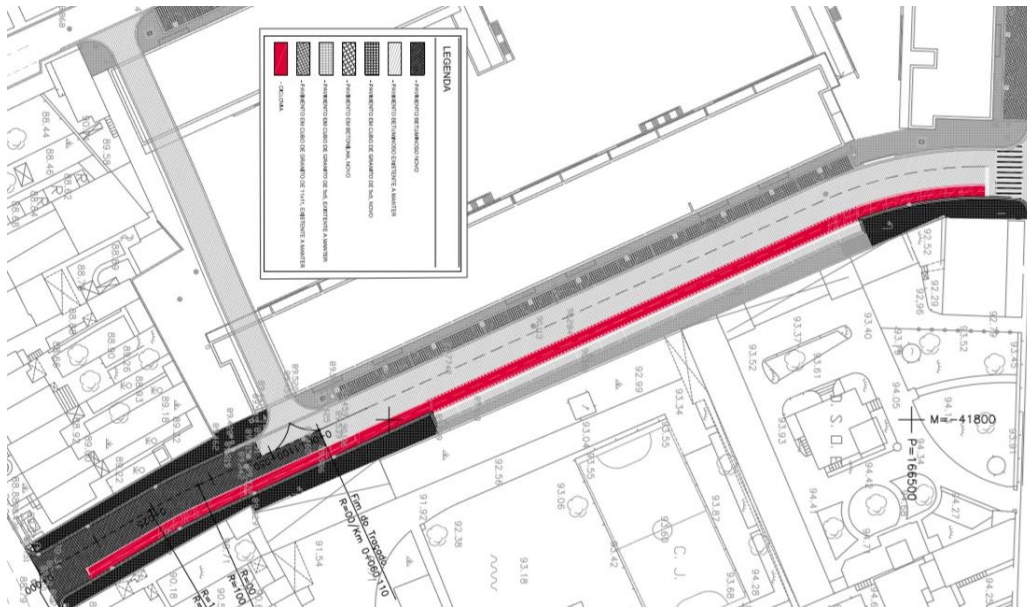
Planta com perspetiva final adaptada da original fornecida por [19]
